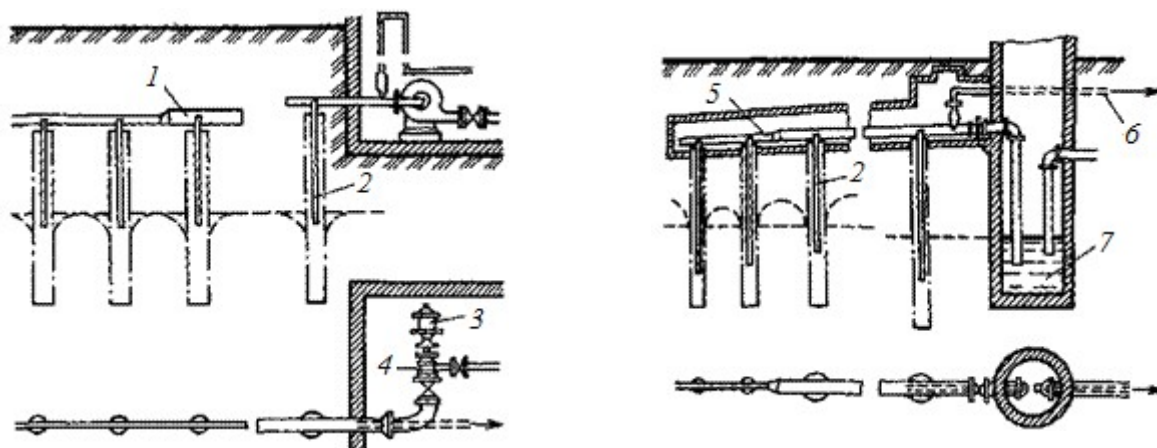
Схема влаштування вертикального дренажу: а) із всмоктуючим трубопроводом; б) з сифоном; 1 – всмоктуючий трубопровід; 2 – всмоктуюча труба; 3 – електродвигун; 4 – насос; 5 – сифонний трубопровід; 6 – до вакуум-насосу; 7 – приймальний резервуар
